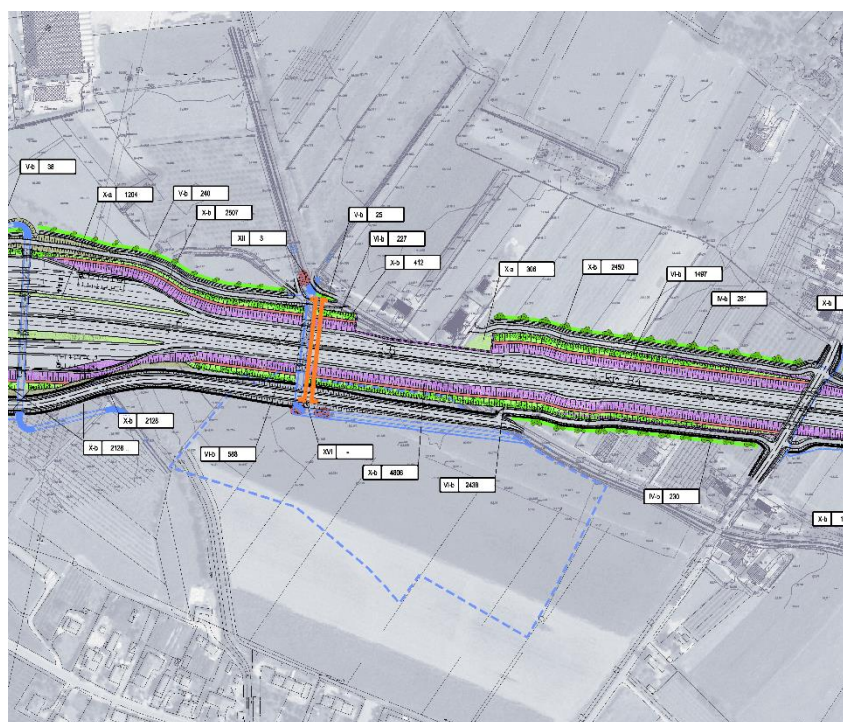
Estratto del progetto esecutivo approvato – Collegamento ramo sud/est (asse 5) con via Lavaio.
